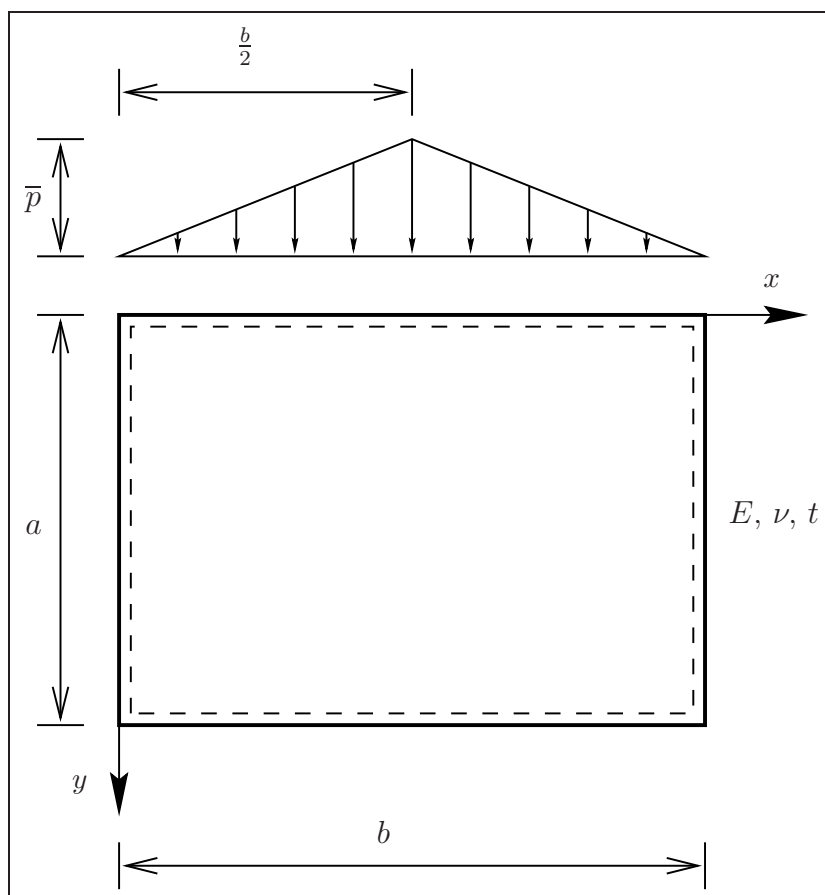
Laje rectangular simplesmente apoiada submetida a carga bilinear.
